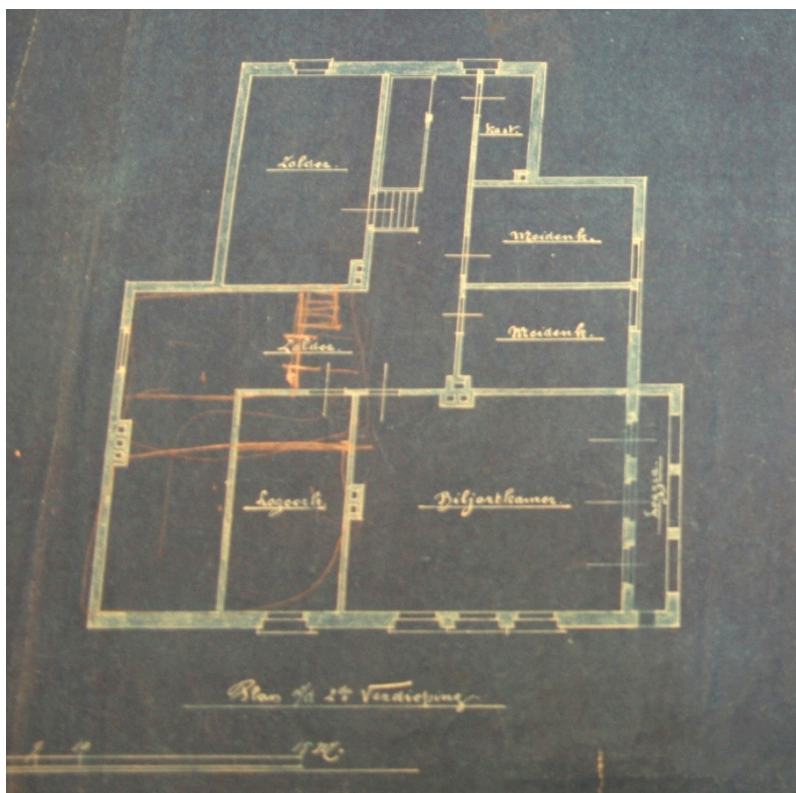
Plan eerste verdieping van H.P. Berlage voor het woonhuis van mevrouw L. van Vloten-van Gennep te Noordwijk aan Zee, 1896.
